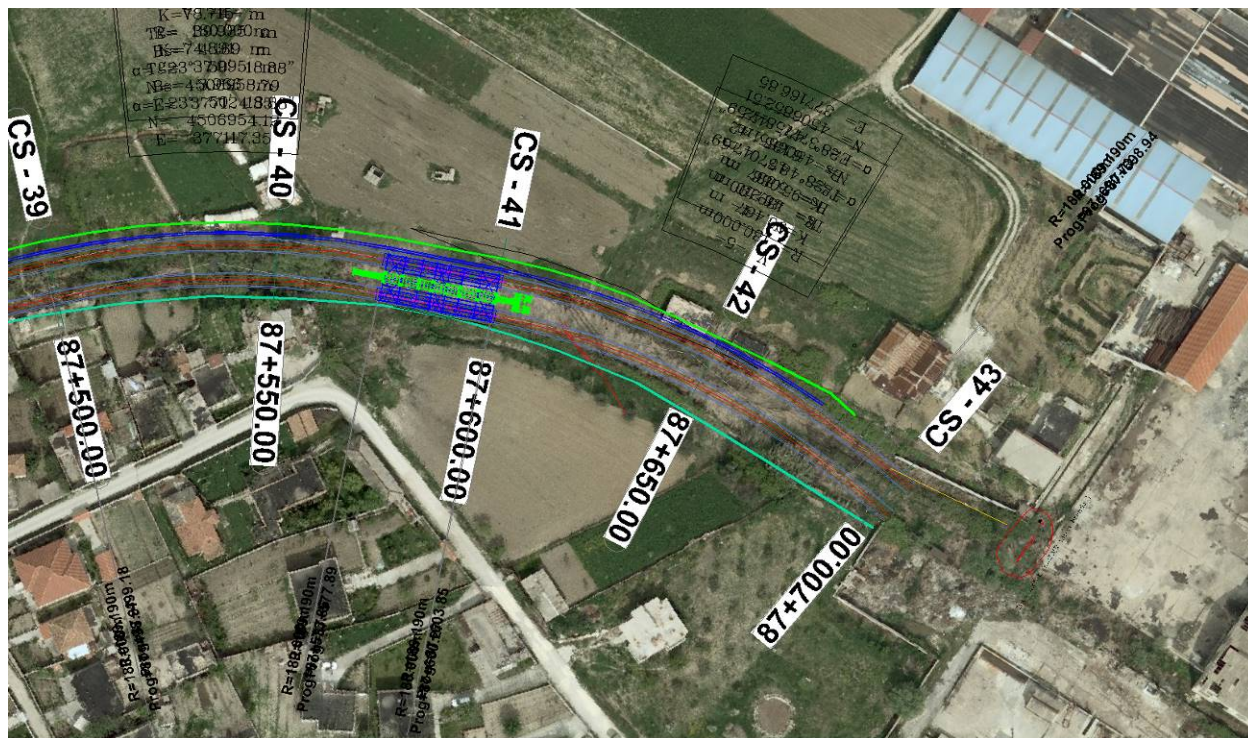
Planimetria e ndërtimit të stacionit të ngarkimit të naftës bruto (Km 87+600)
